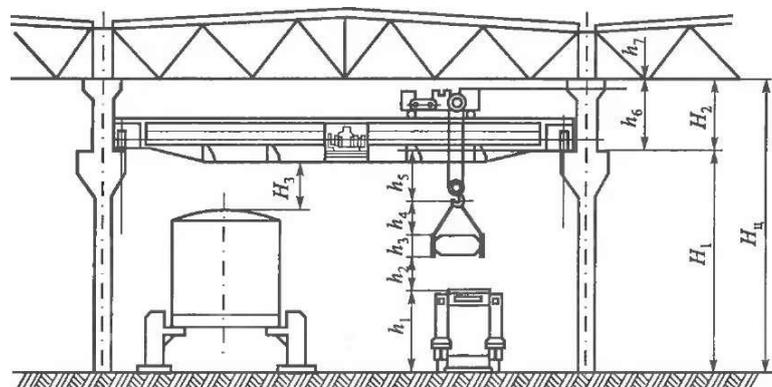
(б). Основные размеры вагоноремонтного цеха
